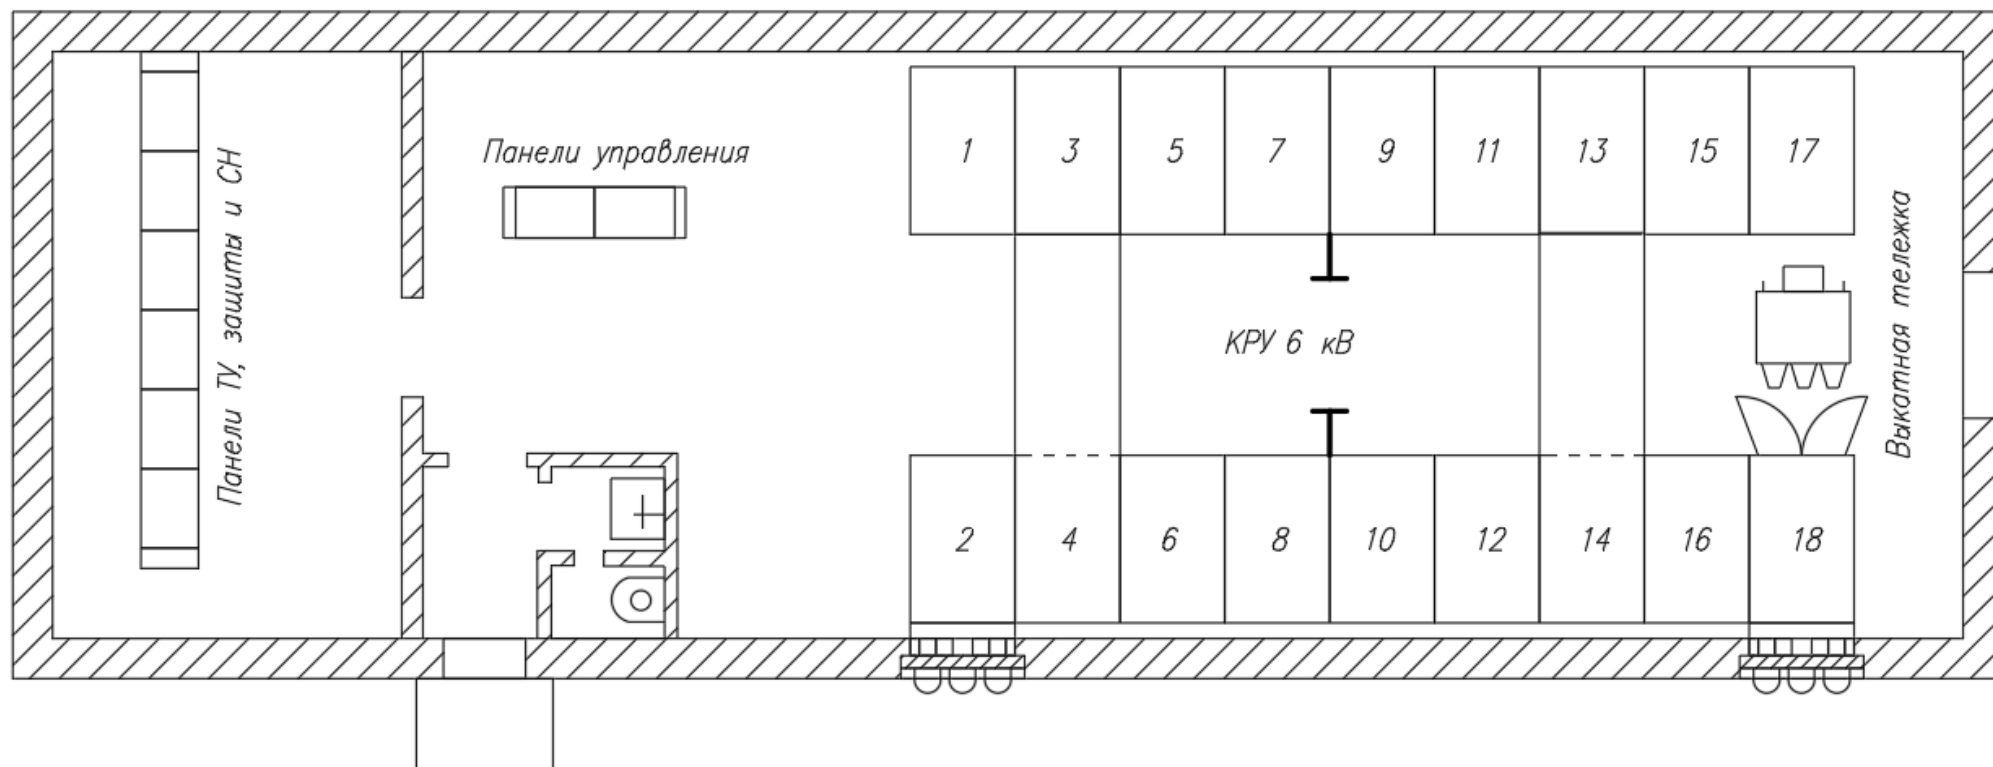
План ЗРУ с размещением ячеек КРУ
